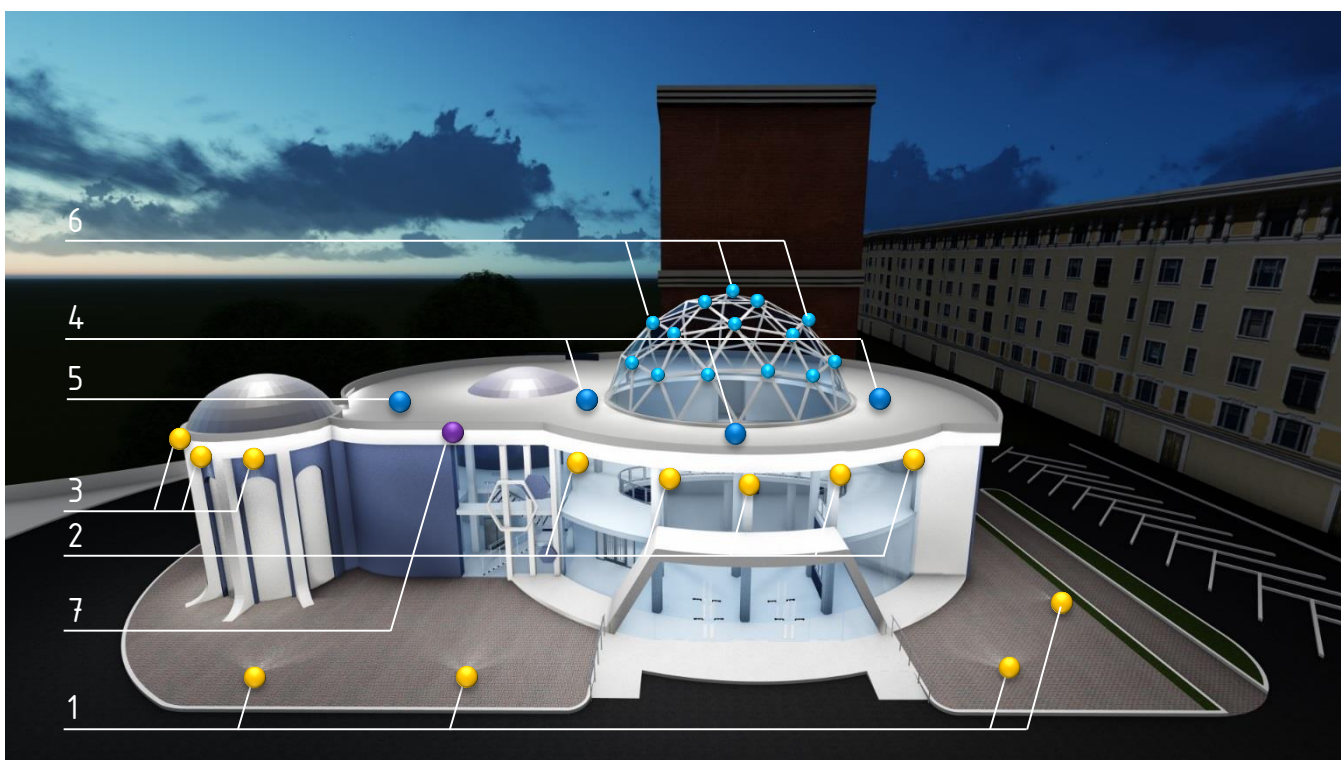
Схема архитектурной подсветки фасада здания Пермского планетария
